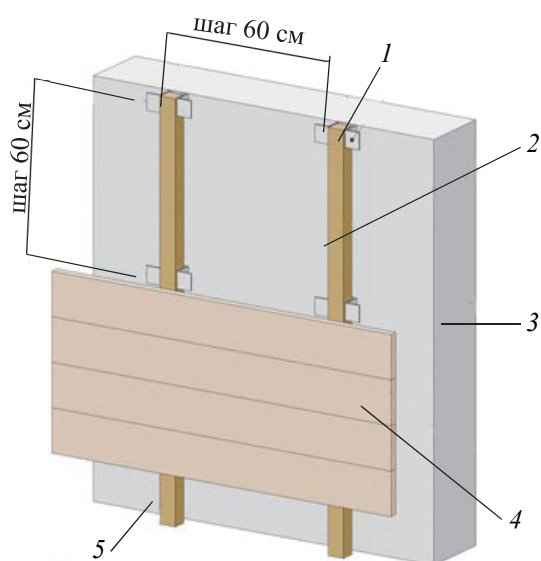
Схема крепления обрешетки к бетонной стеновой панели
